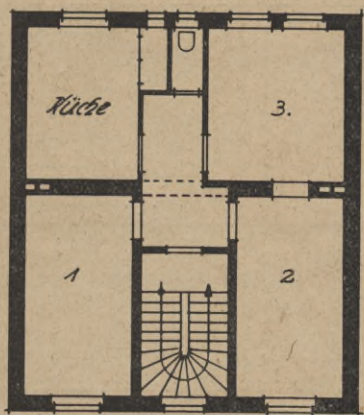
Eingebautes Haus mit 3-Zimmerwohnungen.
